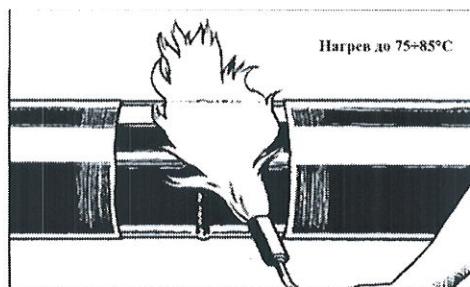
Нагрев зоны сварного стыка
